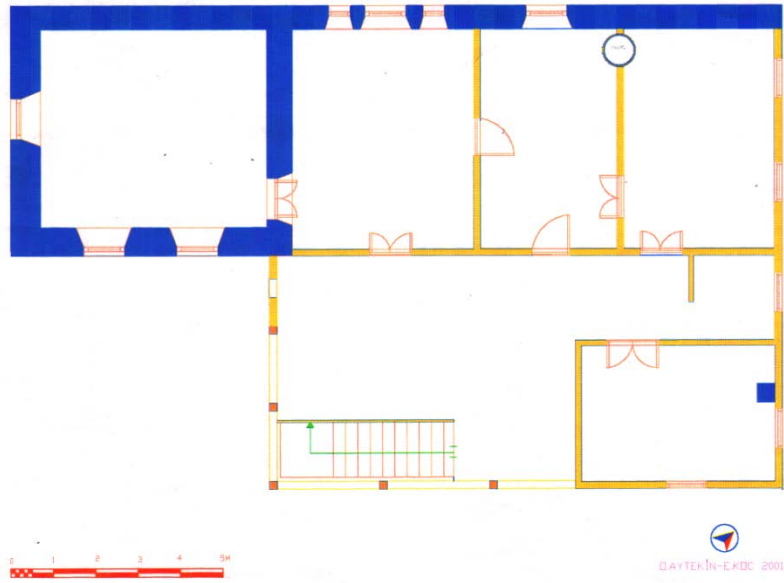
Zeytinlik Köyü Aşağı Türbe planı.
